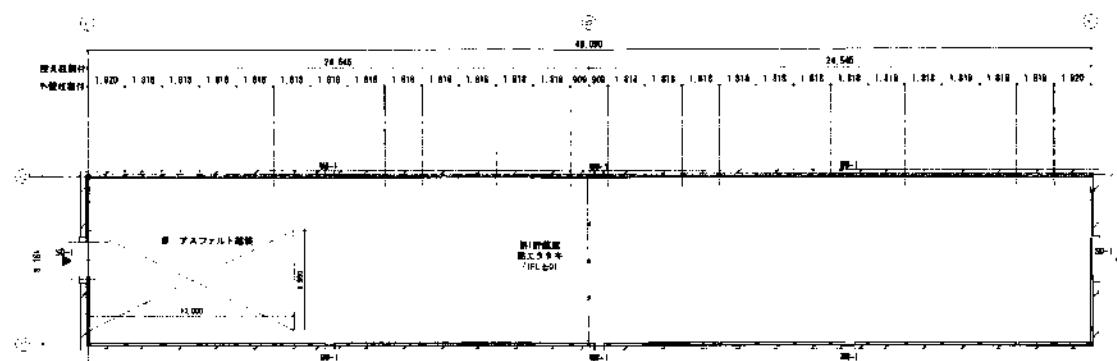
第一貯蔵庫 平面図 (株式会社シン技術コンサル提供)
